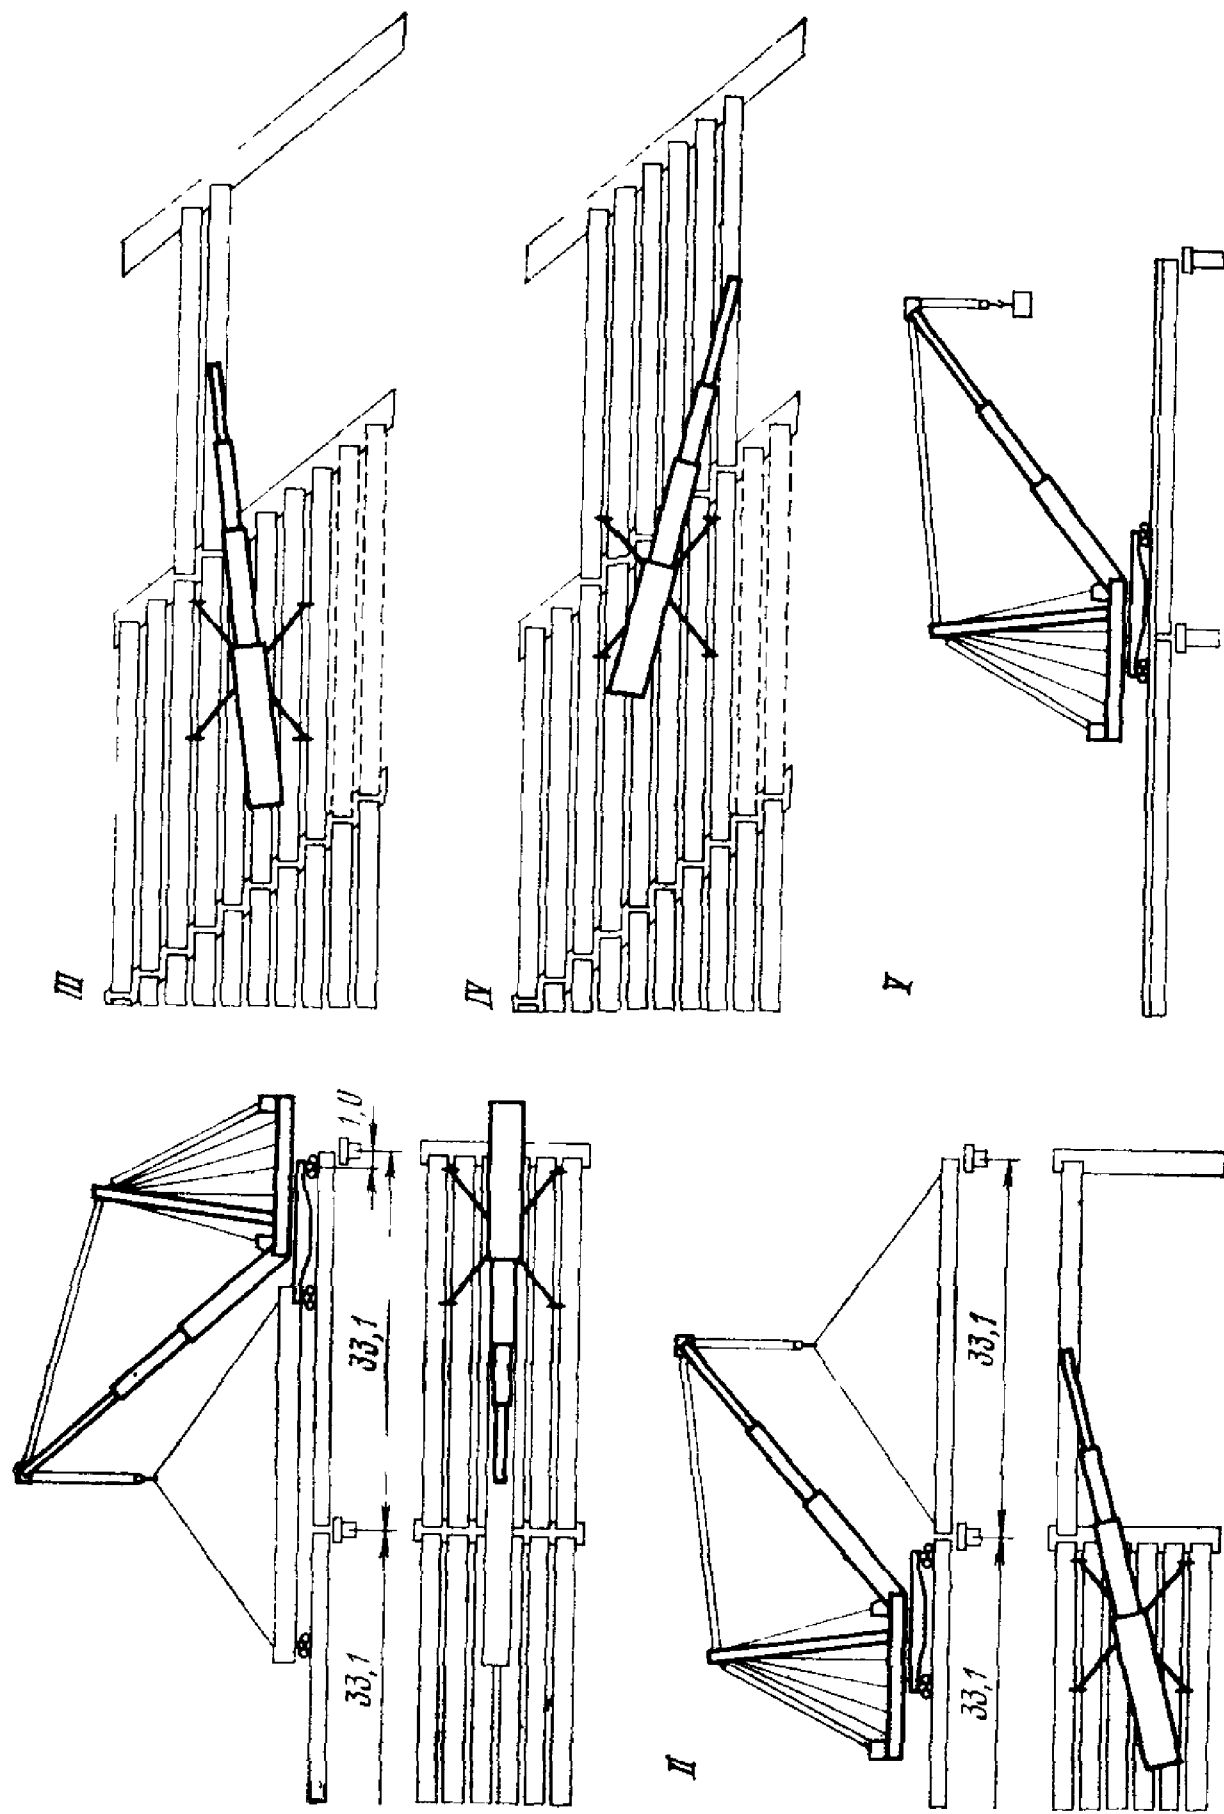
Схема установки балок Краном МК-63 «сверху»:
